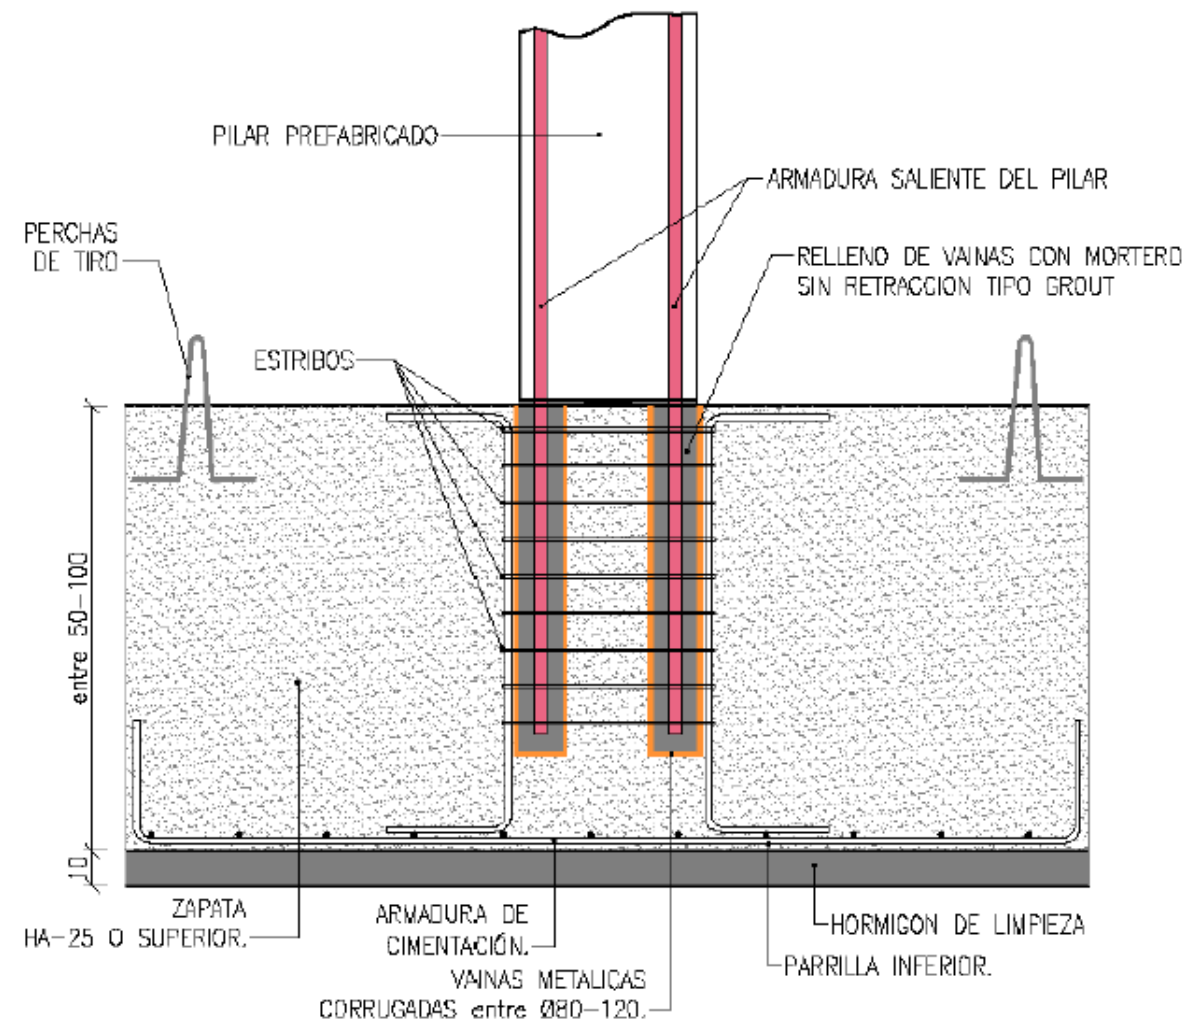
b. Detalle vainas de la zapata. Fuente: catálogo de Pacadar
